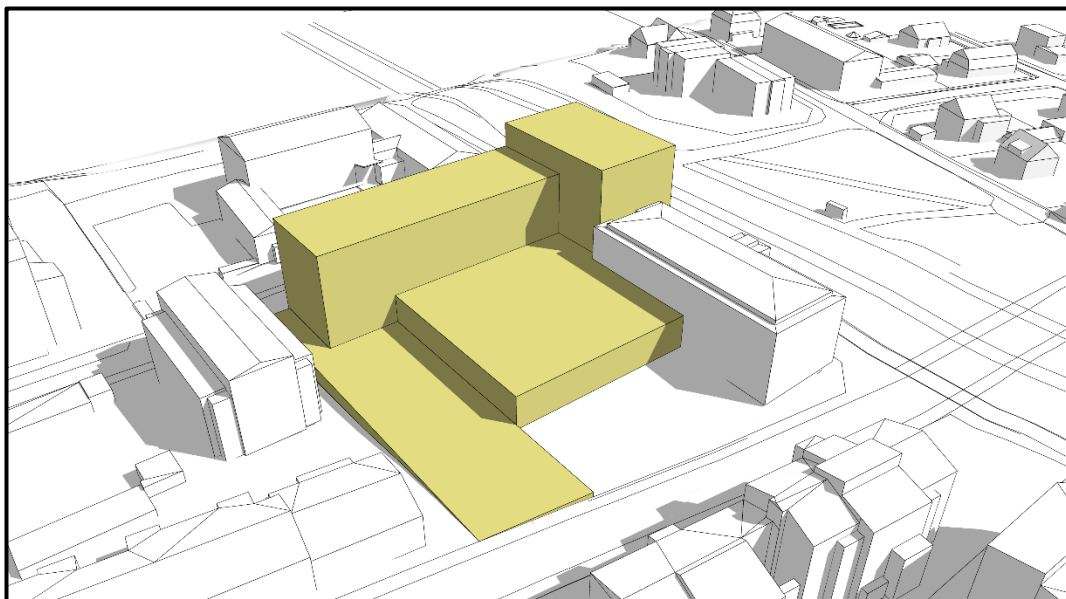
Exempel på utformning av infart till parkeringsanläggningens nedre däck från Skeppargatan. Bilden visar parkeringsanläggningen med högsta tillåtna nockhöjd enligt planen.
